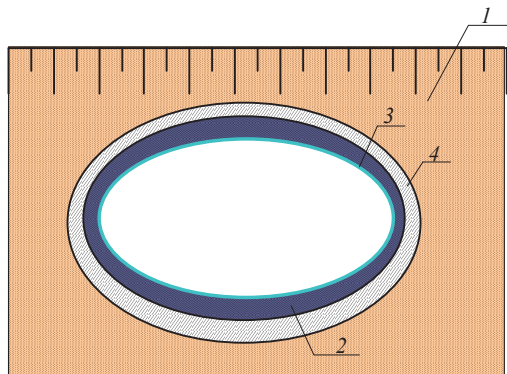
Схематичне зображення ремонту залізобетонних труб за допомогою «методу гільзування»: 1 – насип; 2 – простір заповнений бетоном; 3 – металева гофрована конструкція; 4 – дефектна залізобетонна труба
